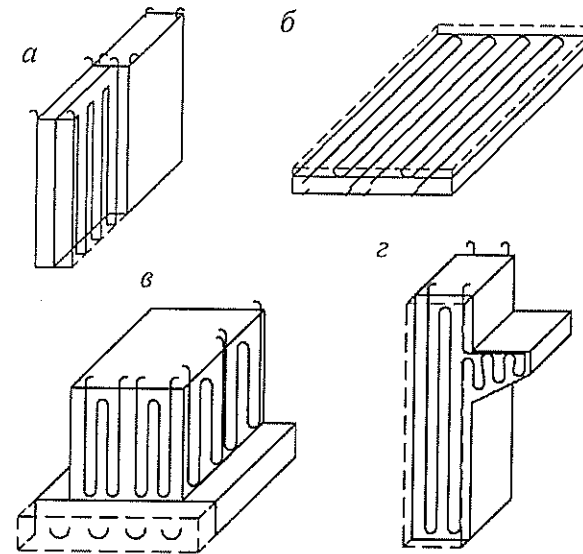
Навивка нагревательных проводов в типовых конструкциях: а – в стенах; б – в перекрытиях; в – в столбчатых фундаментах; г – в колоннах
